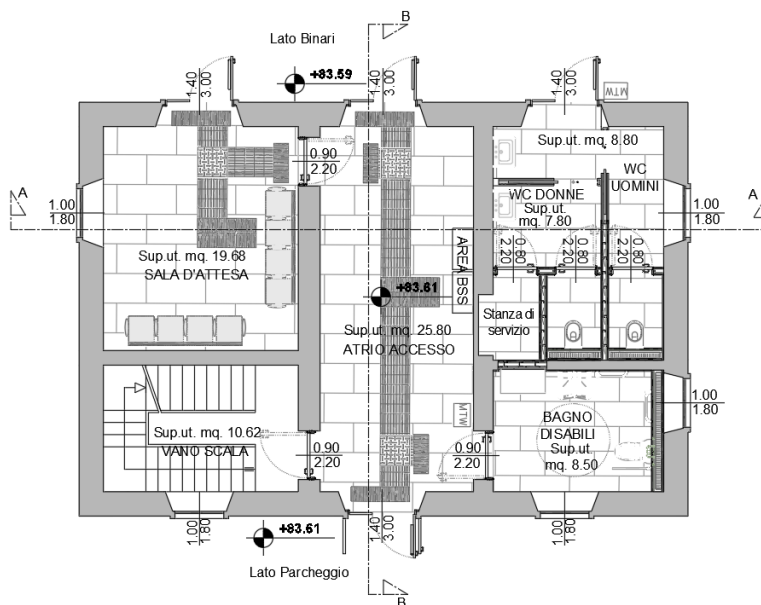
Pianta piano terra Fabbricato Viaggiatori
